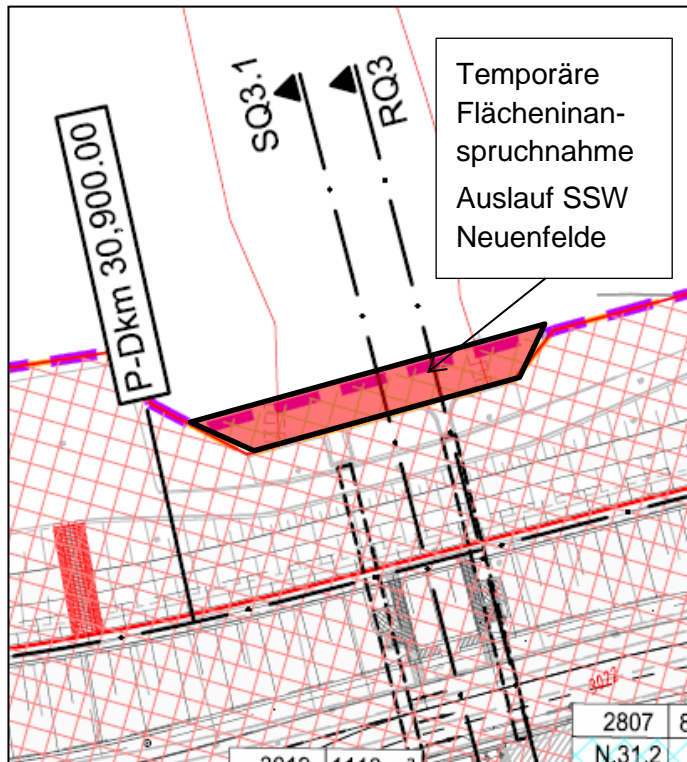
Ausschnitt aus Lageplan „Flächenbedarfsplan PFU 06_N_1“. Quelle: WKC
